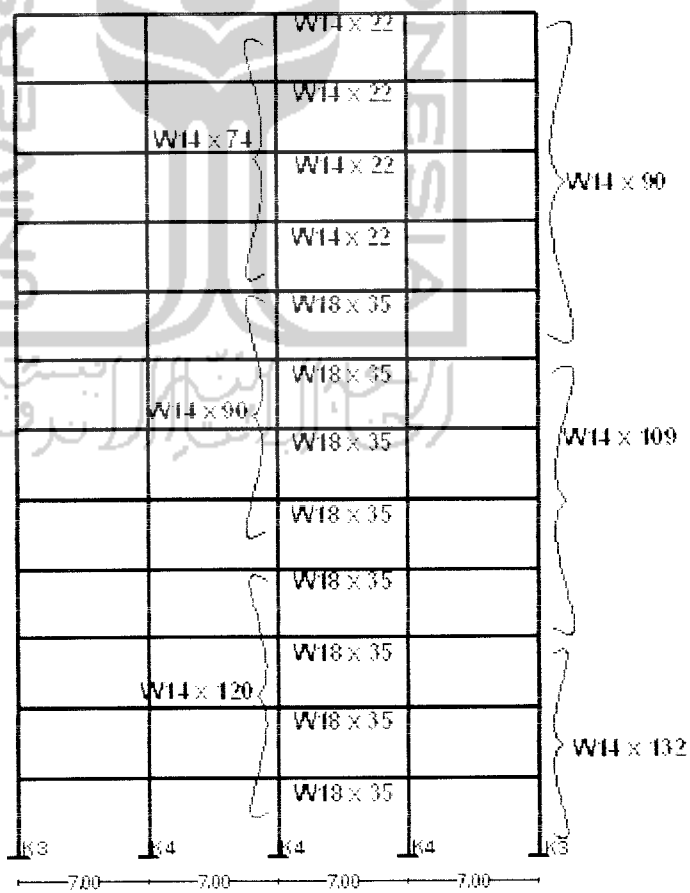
Denah Struktur Dengan Menggunakan Kolom Baja Murni
